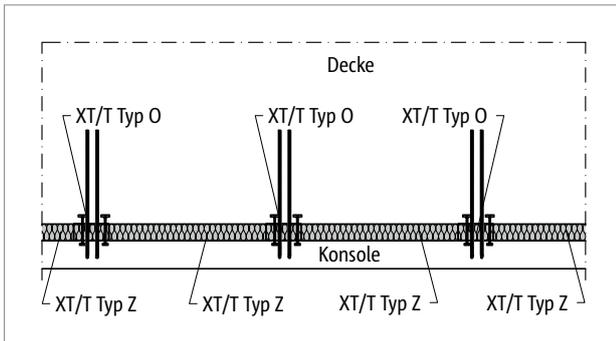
Schöck Isokorb® XT/T Typ O, Z: Konsole
